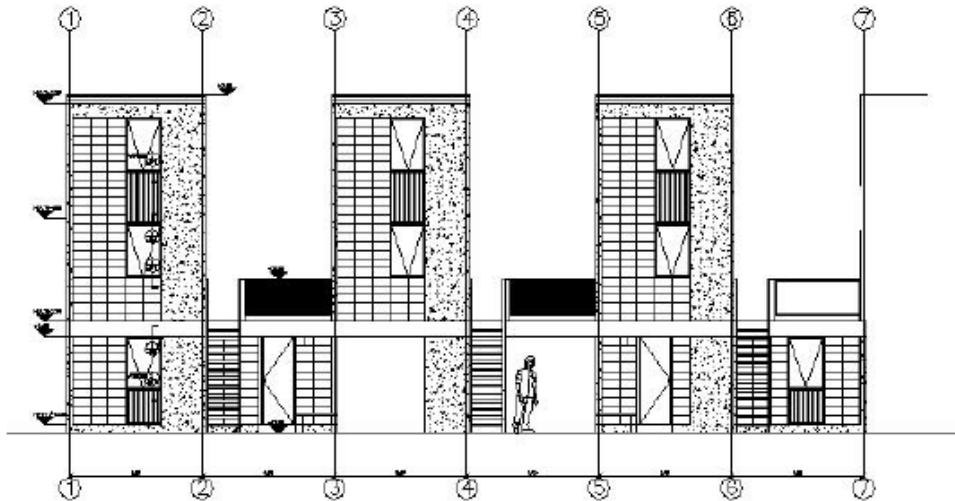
Fachada frontal del edificio destinado a vivienda social.
